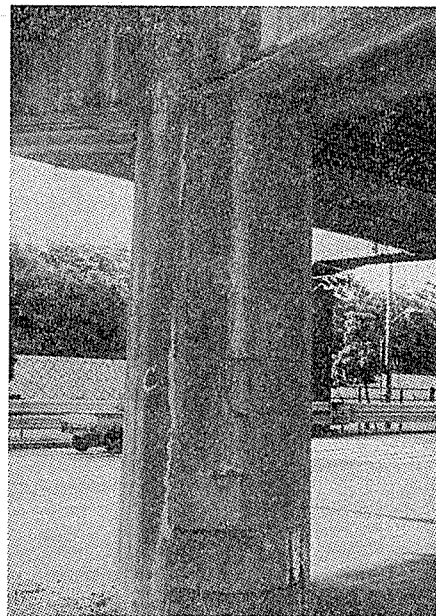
鉄筋コンクリート橋脚、かぶり不足鉄筋の発錆およびかぶり部コンクリートのはく離
